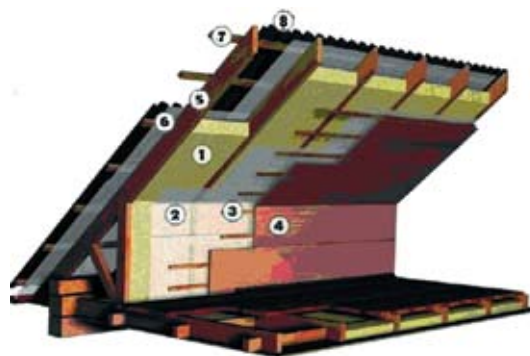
Кровельный пирог чердачной крыши: 1 – утеплитель; 2 – пароизоляция; 3 – внутренняя обрешетка; 4 – внутренняя обшивка мансарды; 5 – стропила; 6 – гидроизоляционная ветрозащитная паропропускная мембрана; 7 – обрешетка под кровельные листы; 8 – кровельное покрытие
